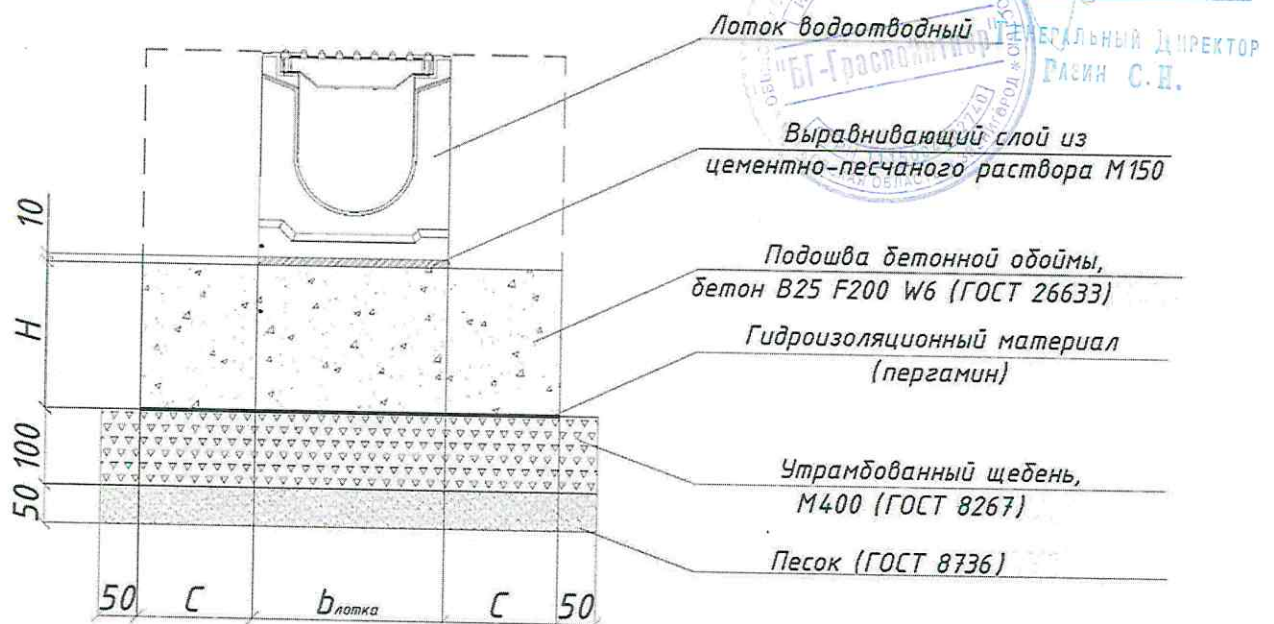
Схема монтажа лотка бетонного водоотводного
